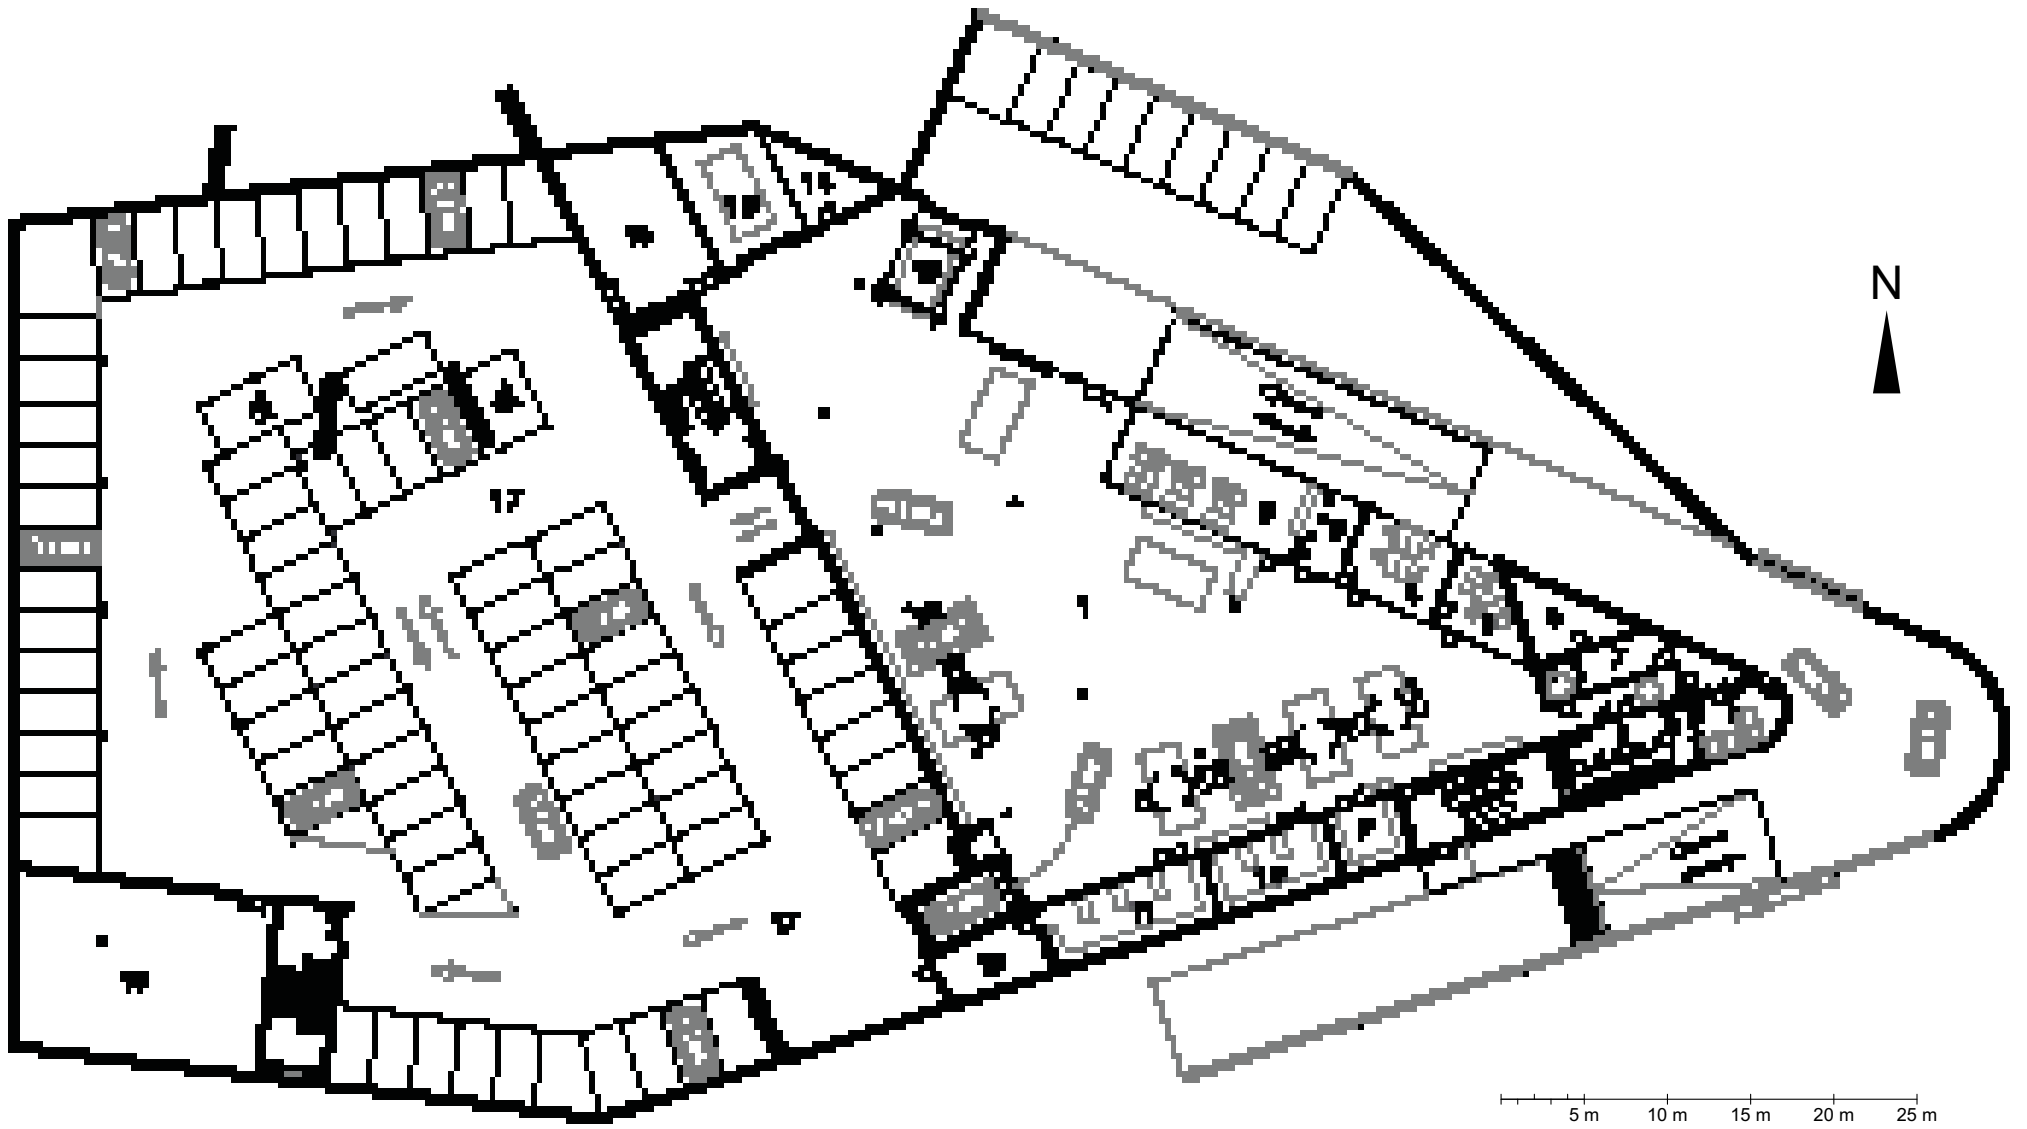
, Grundriss UG1, eigene Darstellung
